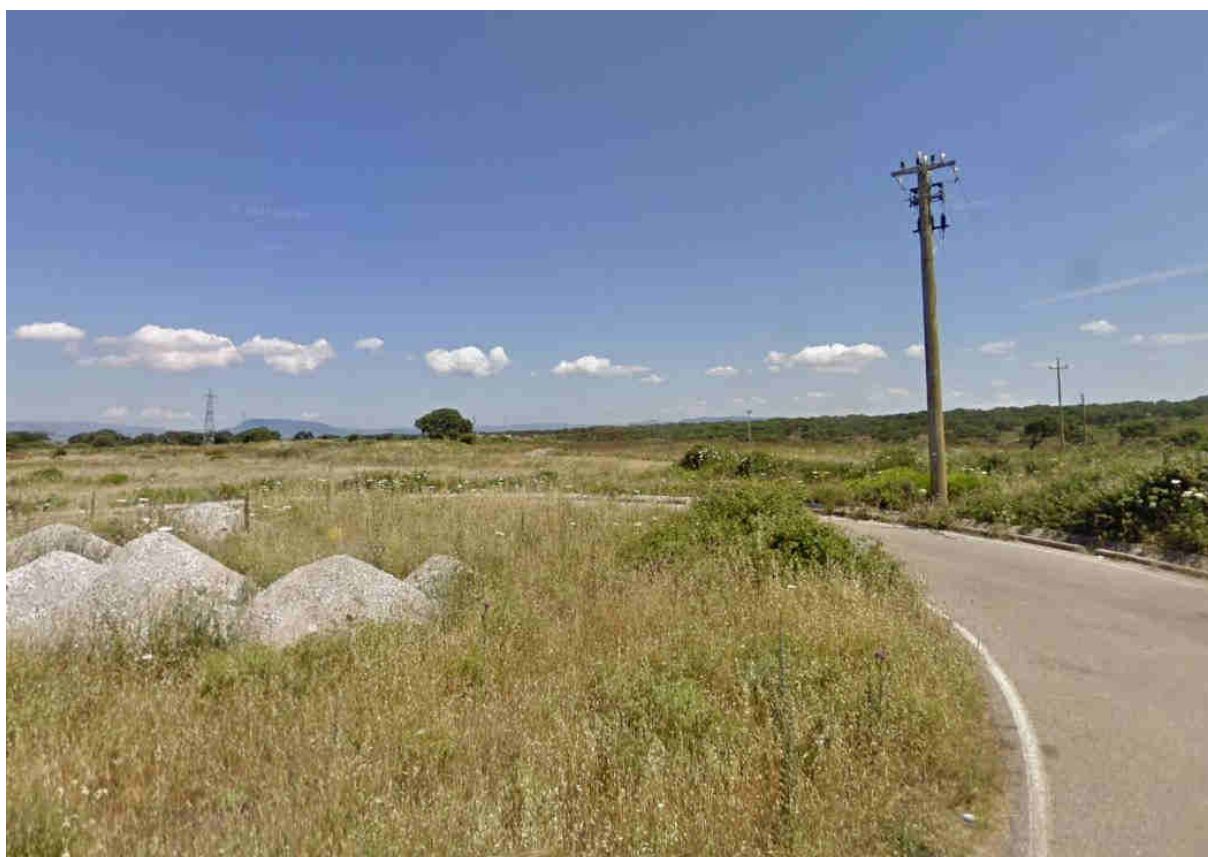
Vista del tratto dove è previsto l'attraversamento delle linee aeree MT sul Riu Ferralzos
